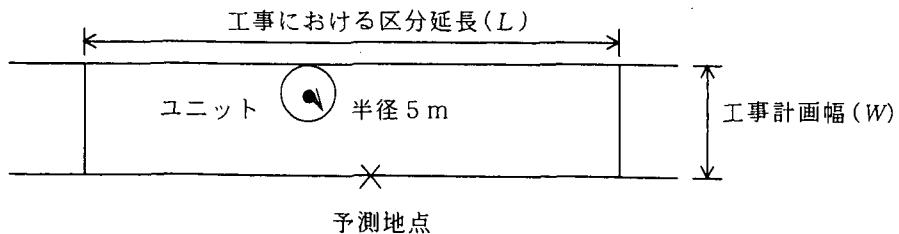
施工範囲が特定される場合の施工範囲とユニットの配置例
